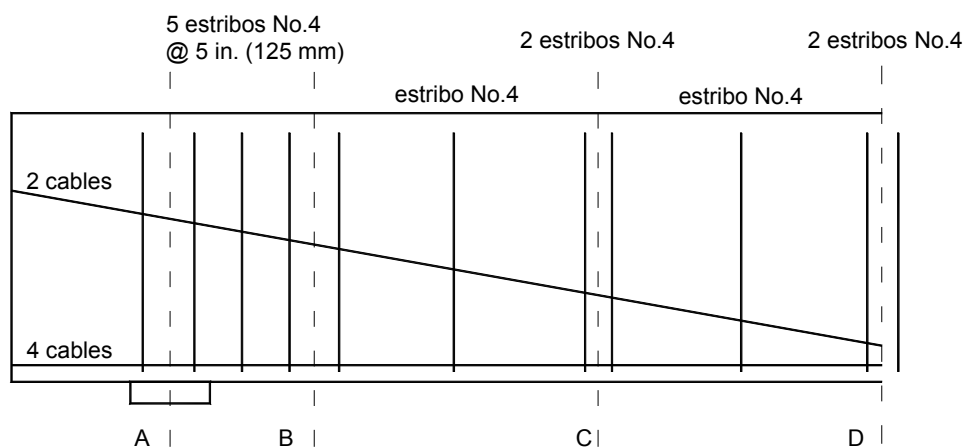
Configuración de las armaduras en el extremo de la viga
